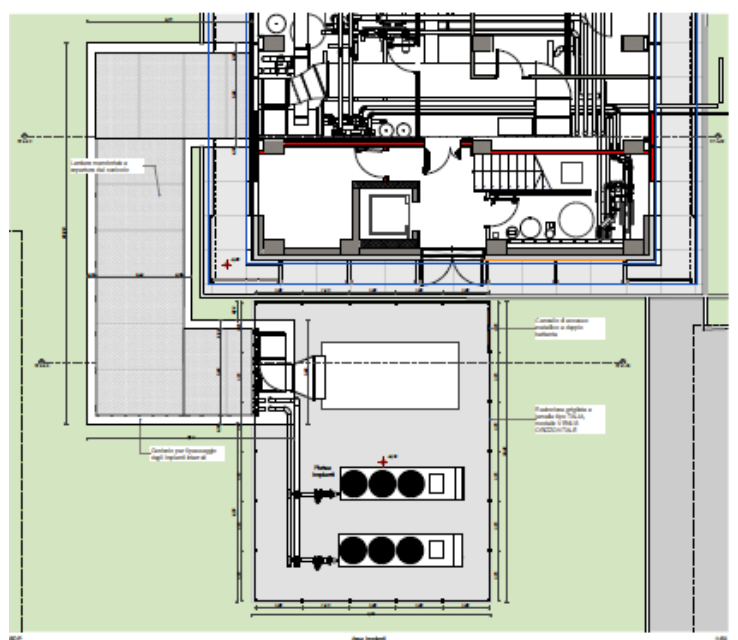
Layout progettuale nuovo edificio Torre 2 – office Block- Area impianti a terra
